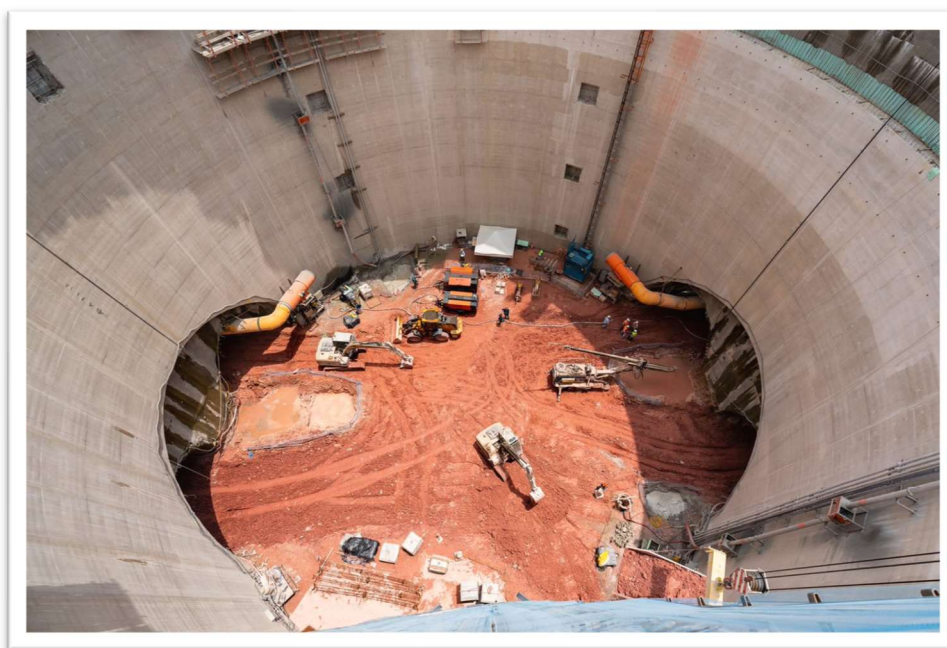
Paredes da Estação Vila Formosa concretadas e seu aspecto final
